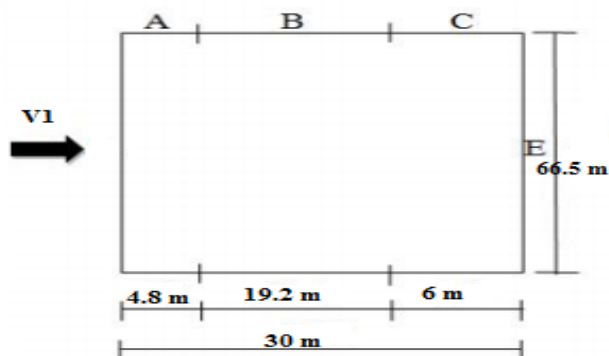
Vue en plan des zones de pression sur les parois verticales suivant le Long-pan
